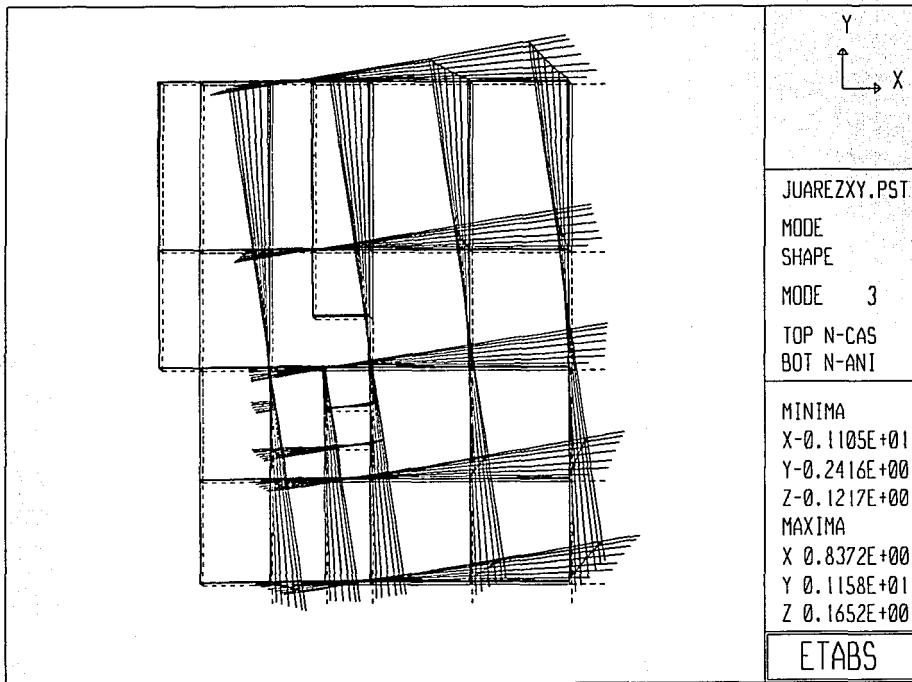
c VISTA EN PLANTA DEL TERCER MODO DE VIBRACION
